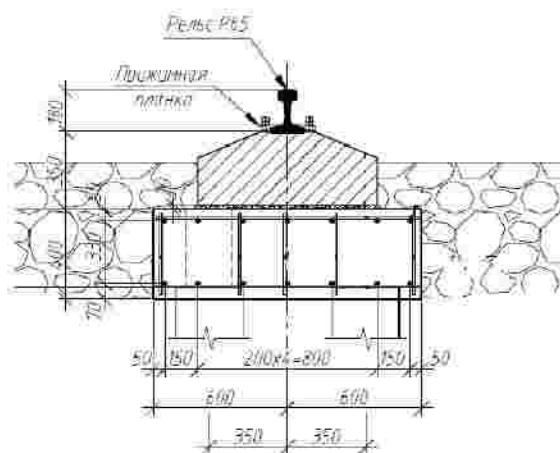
Узел кранового пути на железобетонном фундаменте
